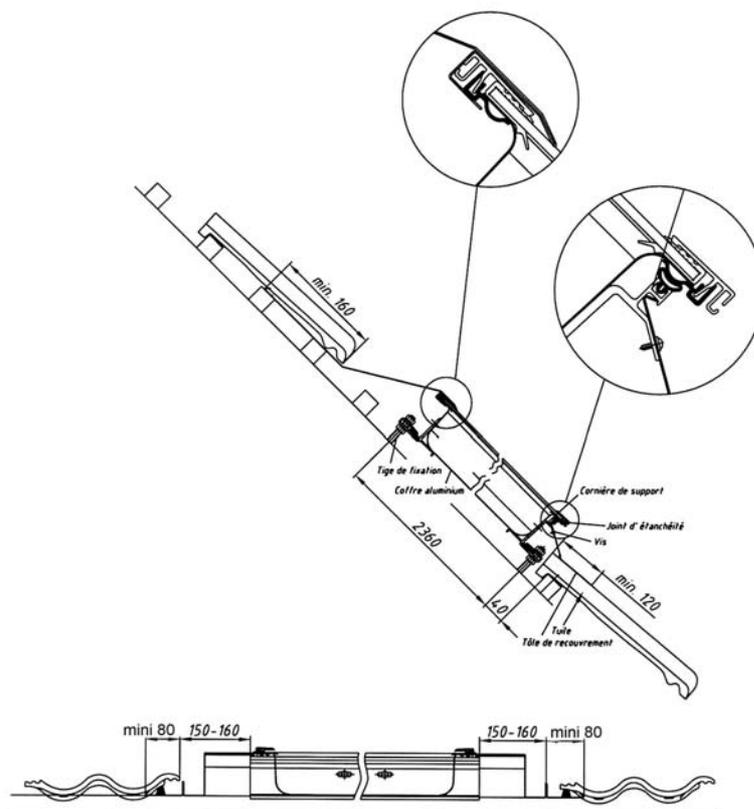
Implantation dans une toiture en tuiles mécaniques– vue en coupe
